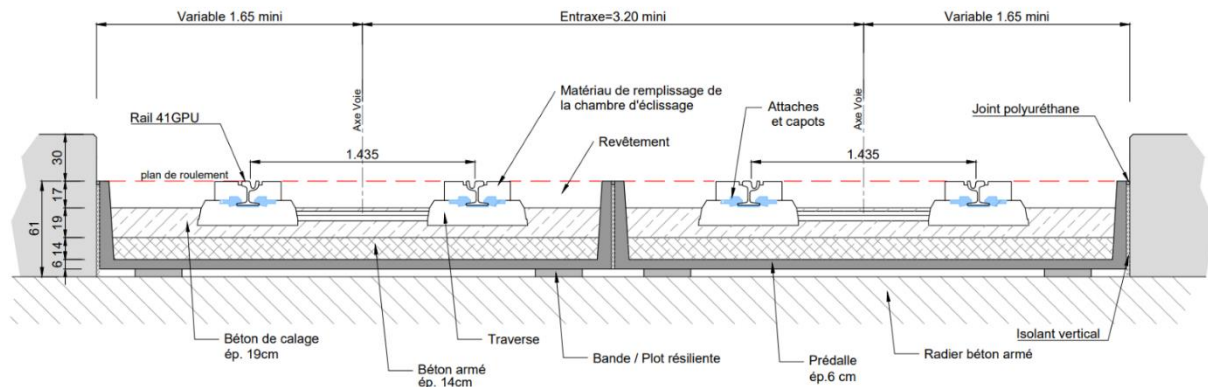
Coupe type avec le système de pose de voie en tunnel, source : Groupement 2025
